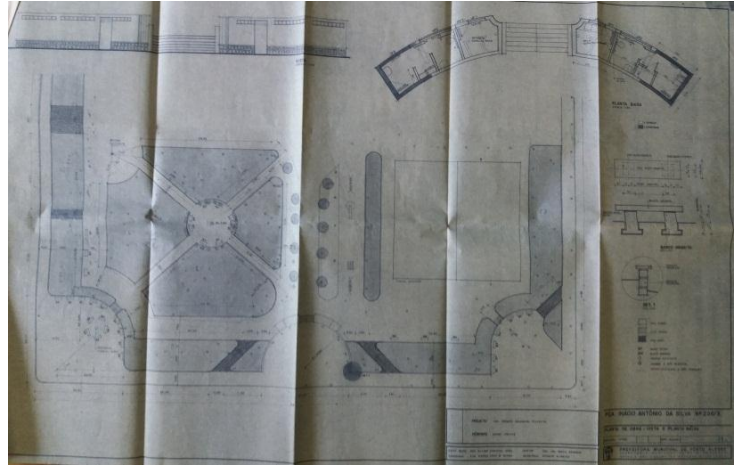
Planta de obra – Vista e Planta Baixa – da Praça Inácio Antônio da Silva (1998).
